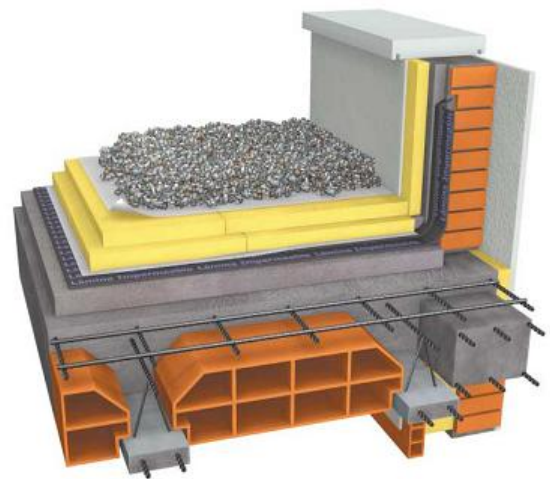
Sección 3D cubierta plana ^[24]
